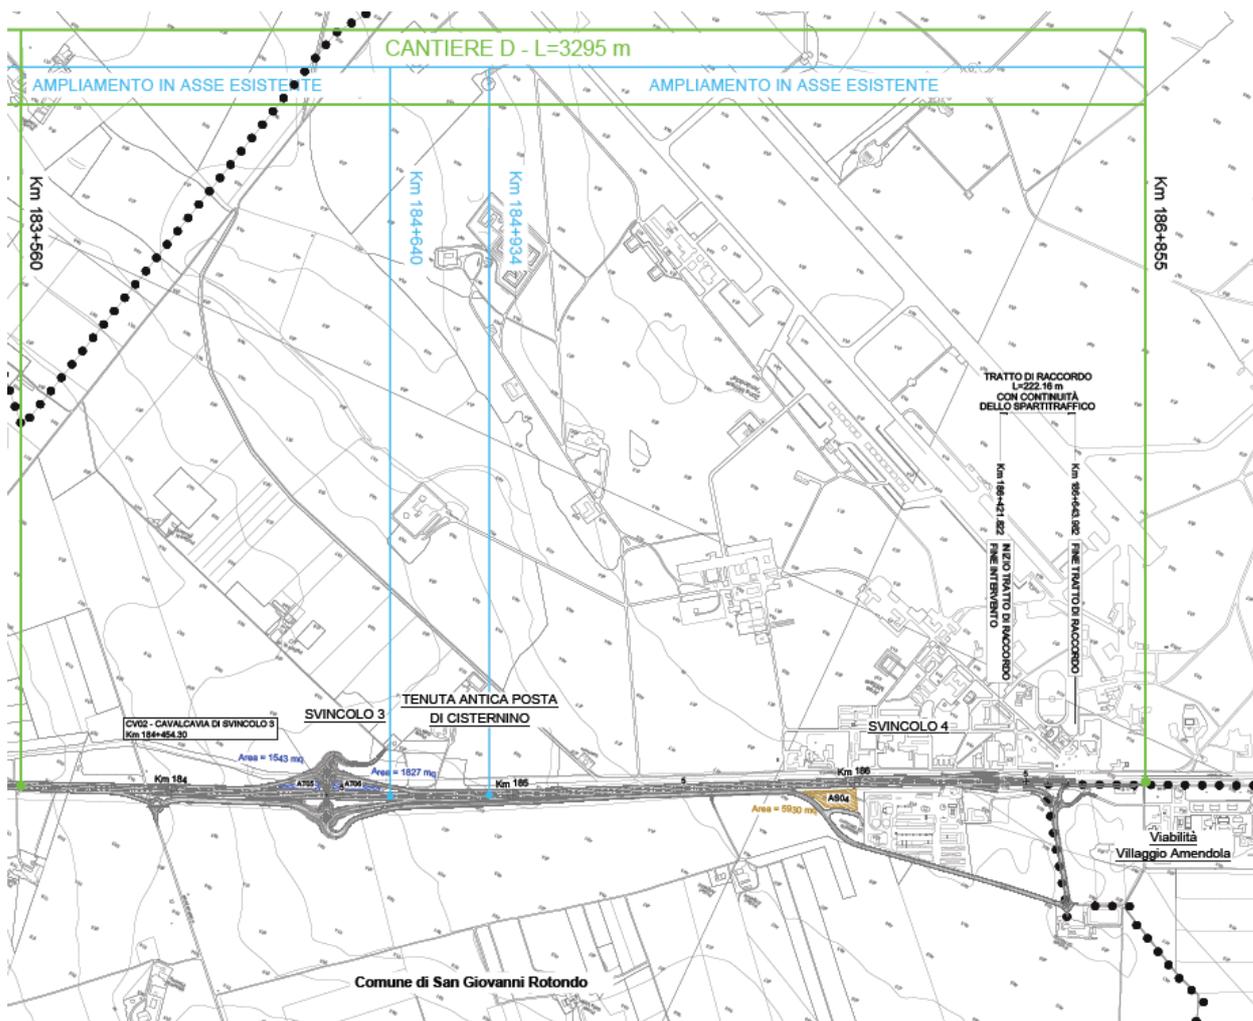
Stralci planimetrici con localizzazione Cantiere D
